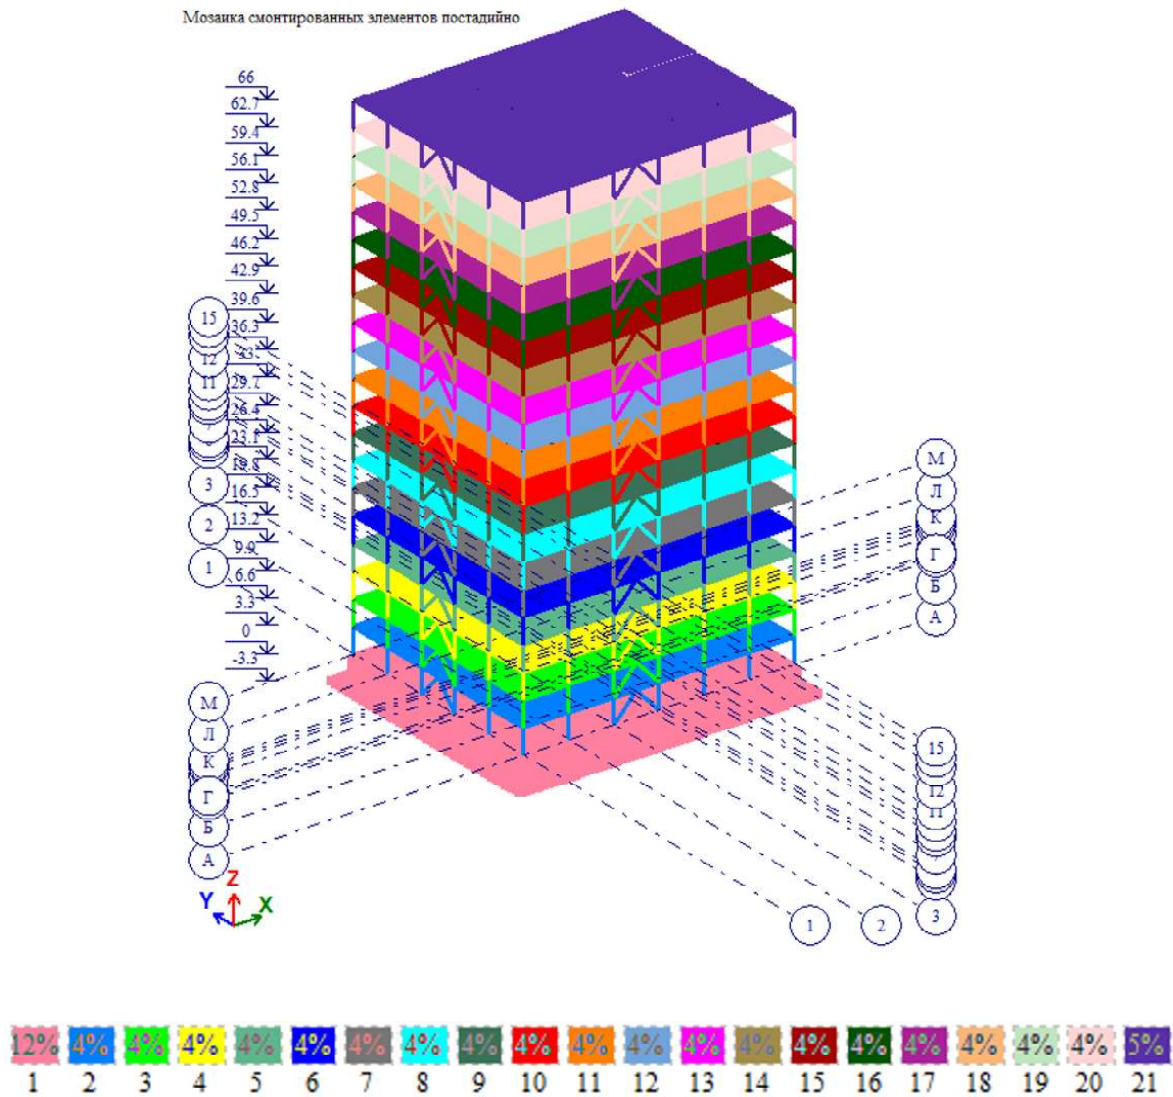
Мозаика поэтажно смонтированных элементов каркаса здания.
